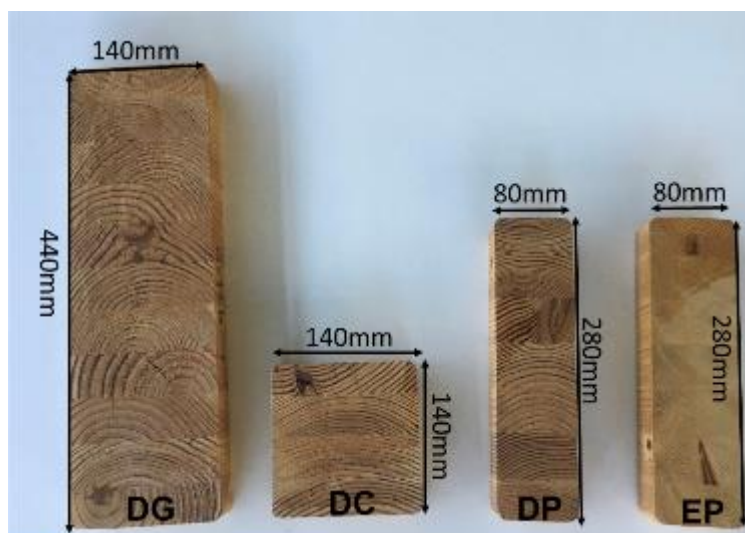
Section des poutres d’approvisionnement LC et BMR
